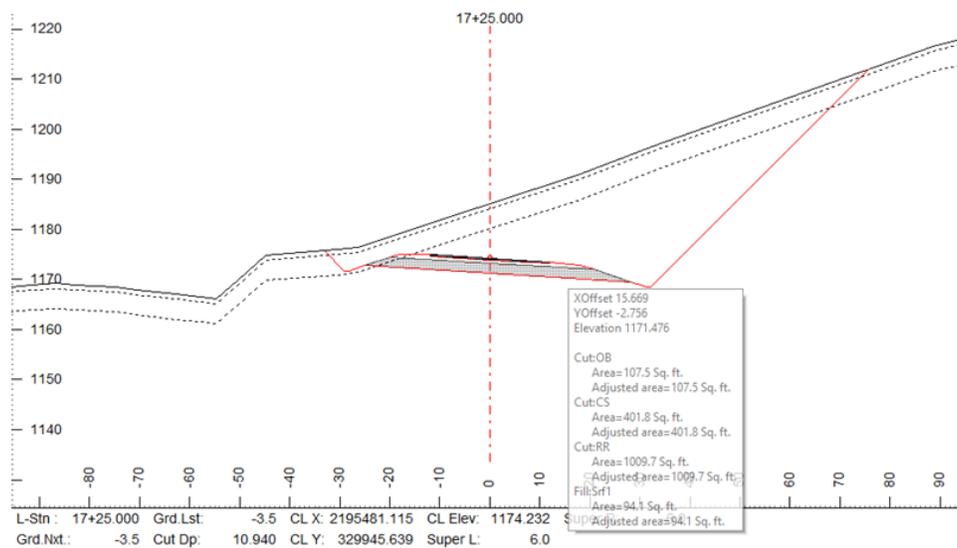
Capas de Terreno mostradas en la Vista de Sección Transversal
